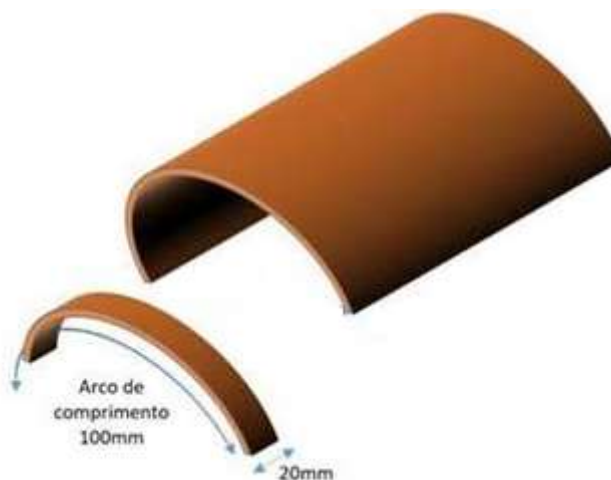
Esquema de corte de corpos de prova para ensaio de flexão.
